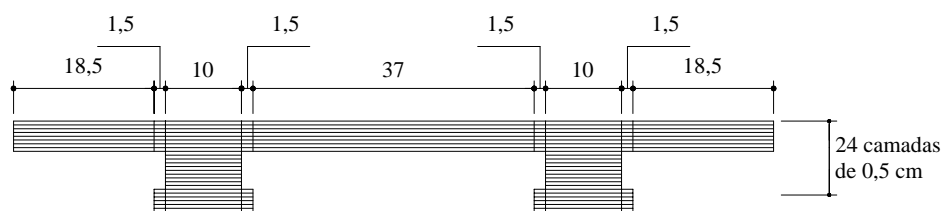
Discretização da seção transversal (dimensões em cm)
